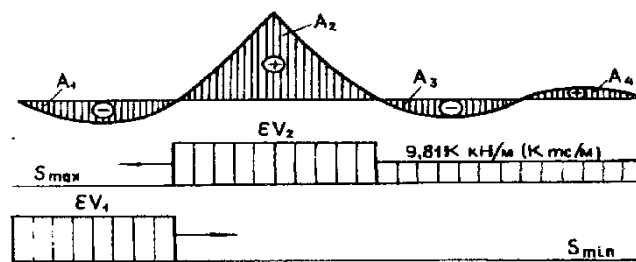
Схема загрузки пролета одновременно с призмой обрушения или пролета с устоем при расчете массивных устоев мостов с разрезными балочными пролетными строениями
